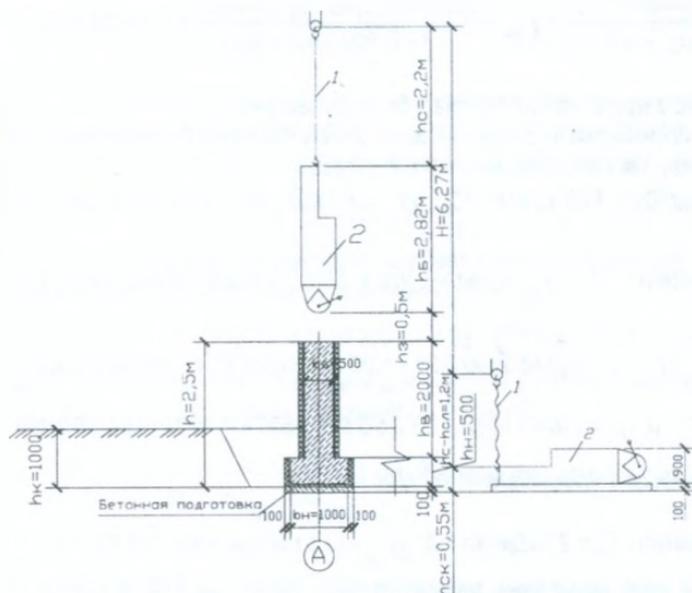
Схема к определению высоты подачи бетонной смеси в опалубку ленточного фундамента краном в бадьях с размещением крана на бровке для рассматриваемого примера
